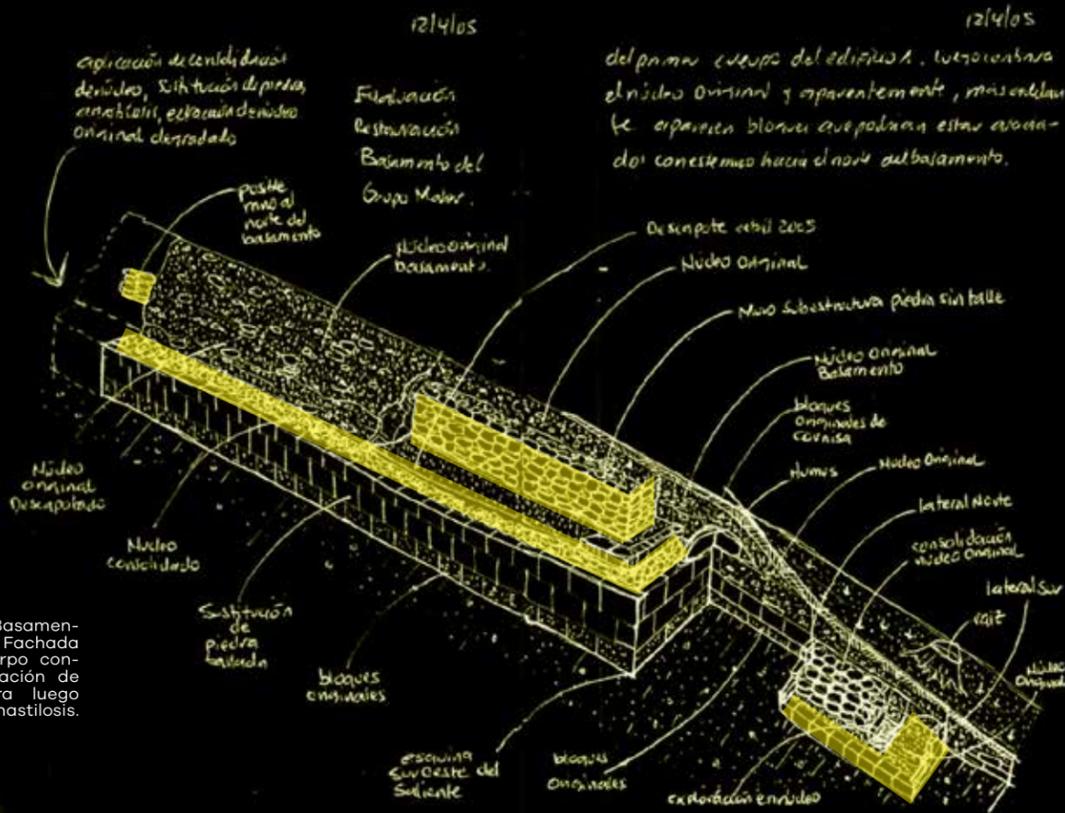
Dibujo Basamento del Grupo Maler, Fachada oeste, primer cuerpo consolidación e integración de fachada de piedra luego del descapote y anastilosis. Dibujo: GAMH 2002
